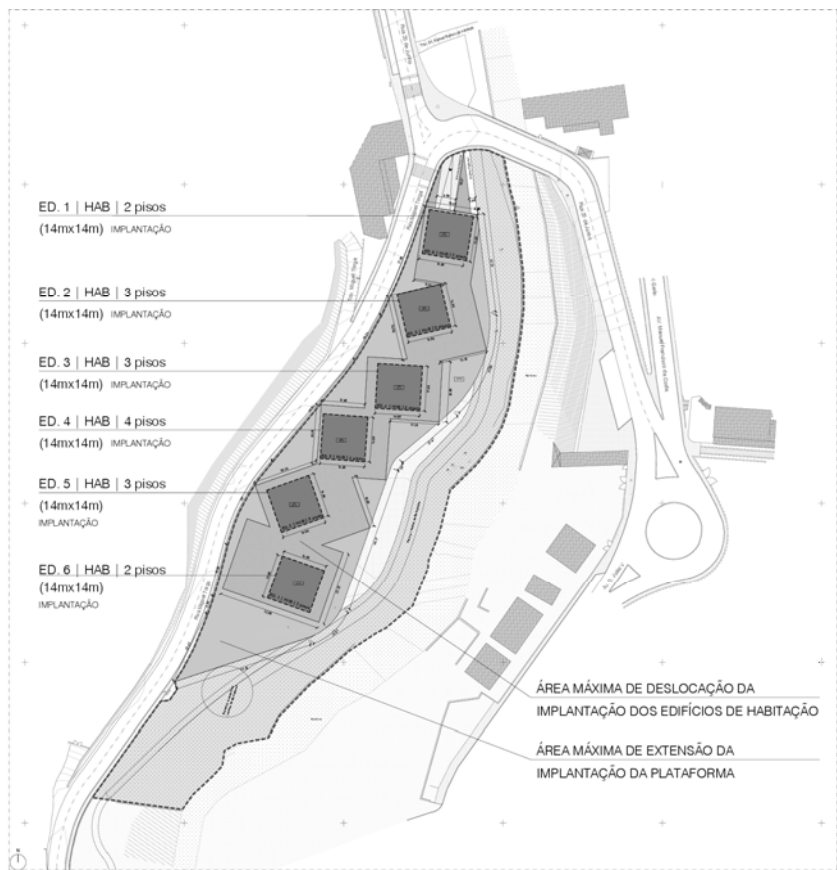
Extrato esquemático da planta do Plano de Pormenor | Planta de Implantação das áreas destinadas aos edifícios de habitação
